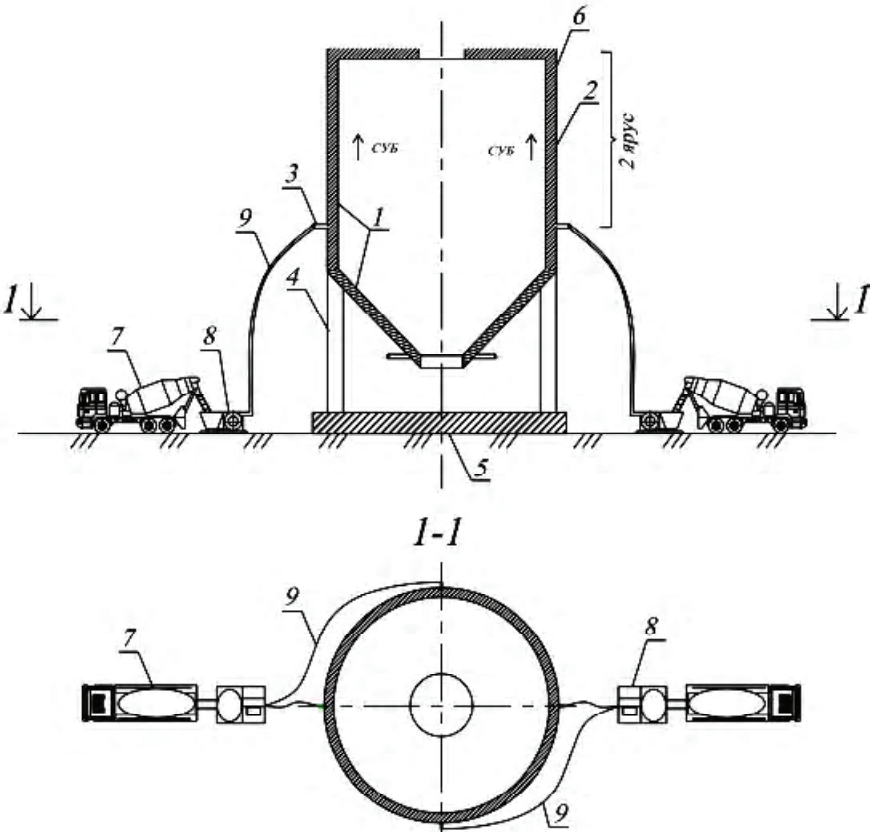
Бетонирование 2-го яруса бункера: 1 – внутренняя опалубка; 2 – наружная опалубка; 3 – штуцеры для подачи бетона; 4 – колонны; 5 – фундамент; 6 – самоуплотняющийся бетон 2-го яруса; 7 – автобетоносмеситель; 8 – роторный насос; 9 – шланг для подачи бетона.
